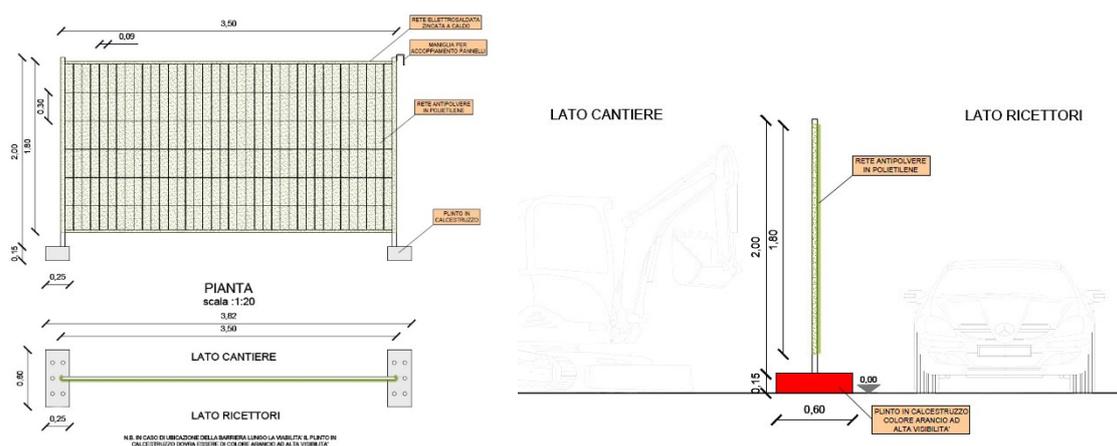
Barriera antipolvere: pianta prospetto e sezione
